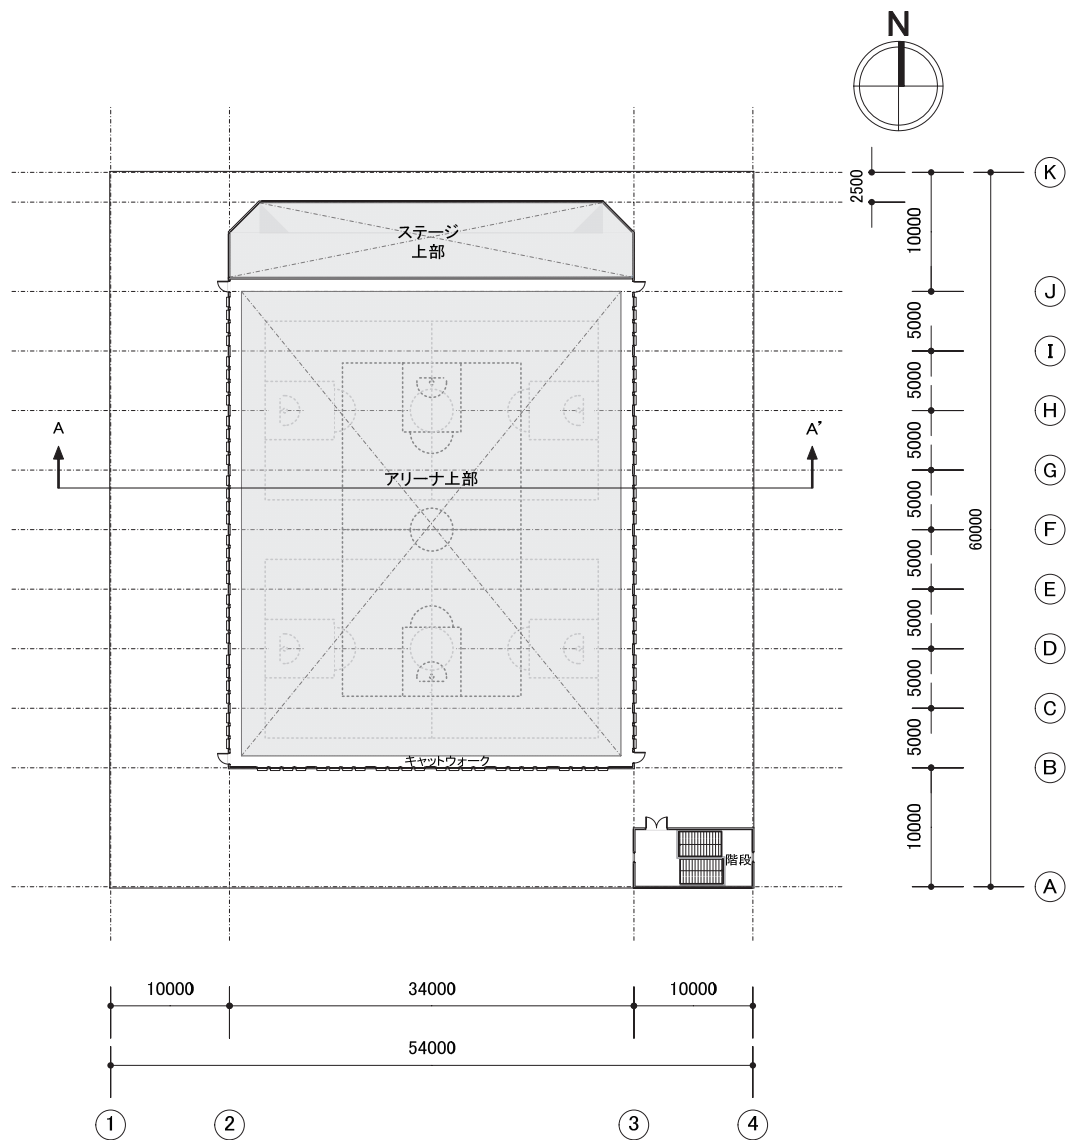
A.27 モデル建物（学校等・講堂、5,000㎡） 3階平面図
